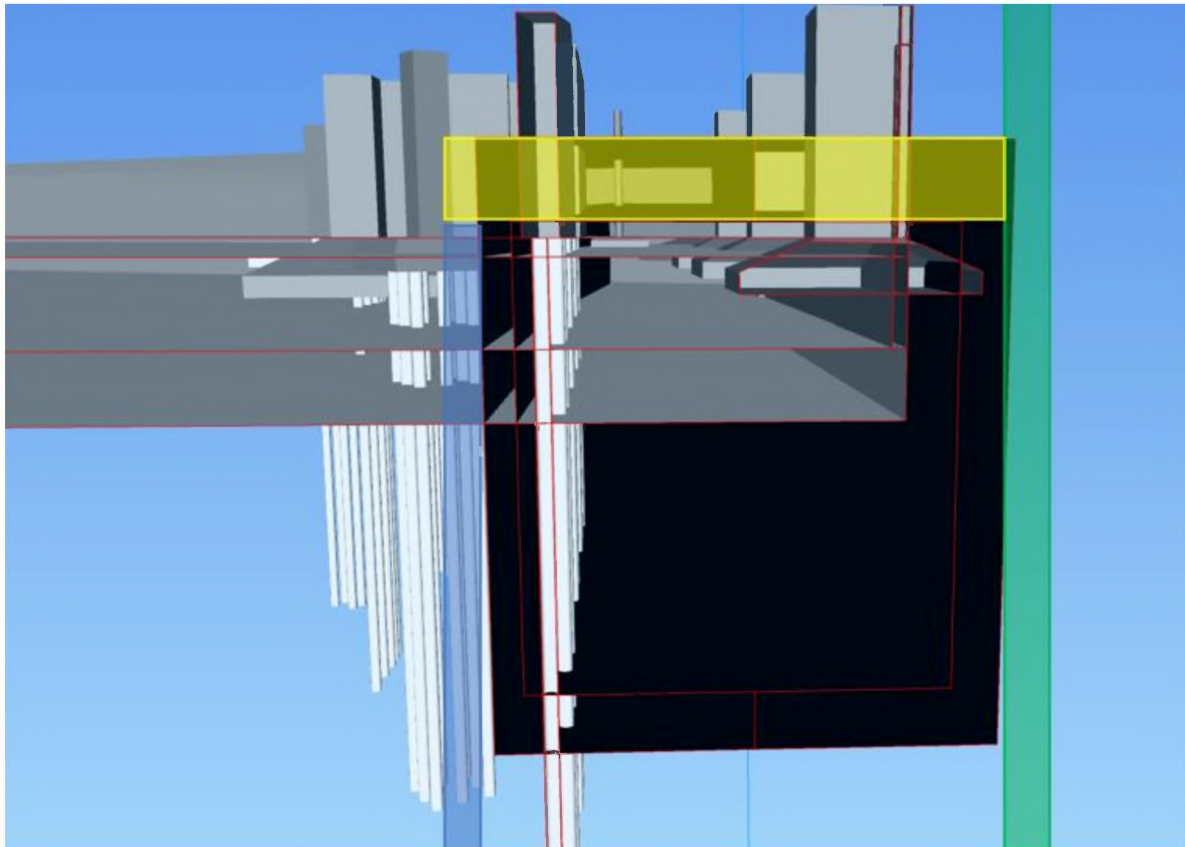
Querschnitt durch den Tunnel beim Bieberhaus mit den Abfangkonstruktionen
